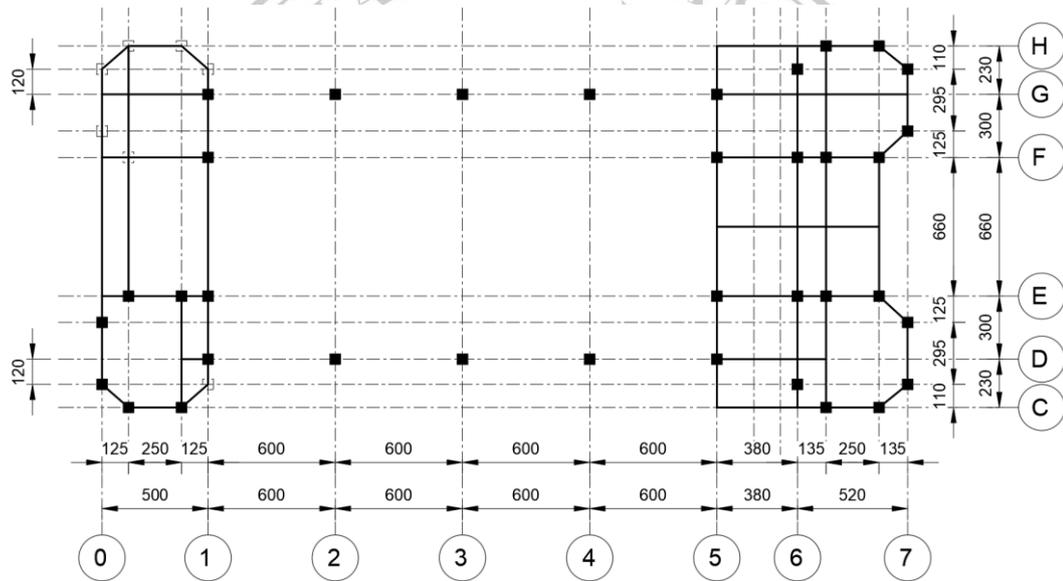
2 Denah lantai 1-4 elevasi +8,40-16,80
